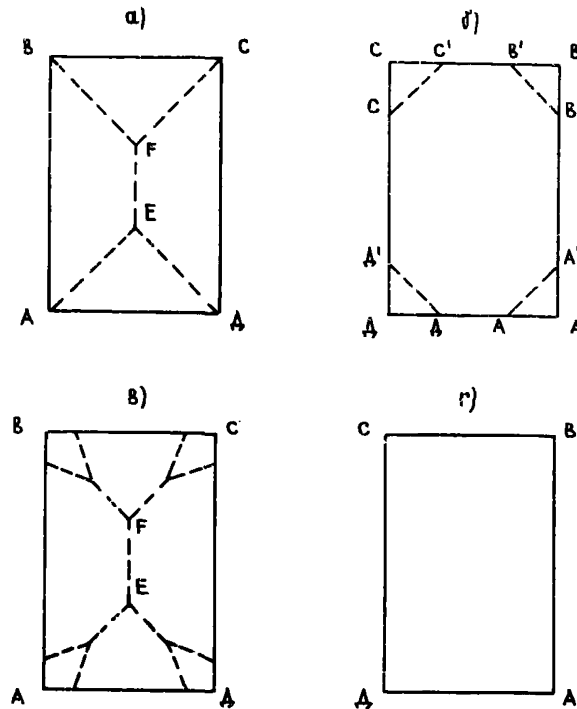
Схемы трещинообразования и излома плит, свободно шарнирно-опертых по контуру: а,в - нижняя поверхность; б,г - верхняя поверхность
